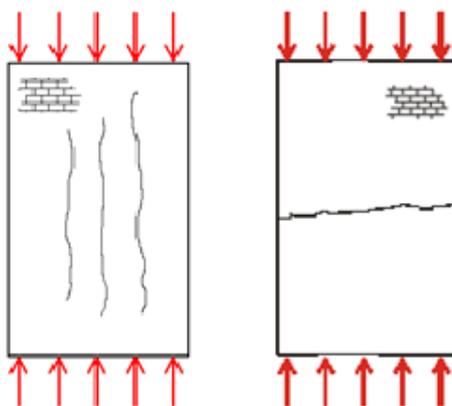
Fissuras verticais e horizontal causadas por sobrecarga (Fonte: DUARTE, 1998 apud MAGALHÃES, 2004)
